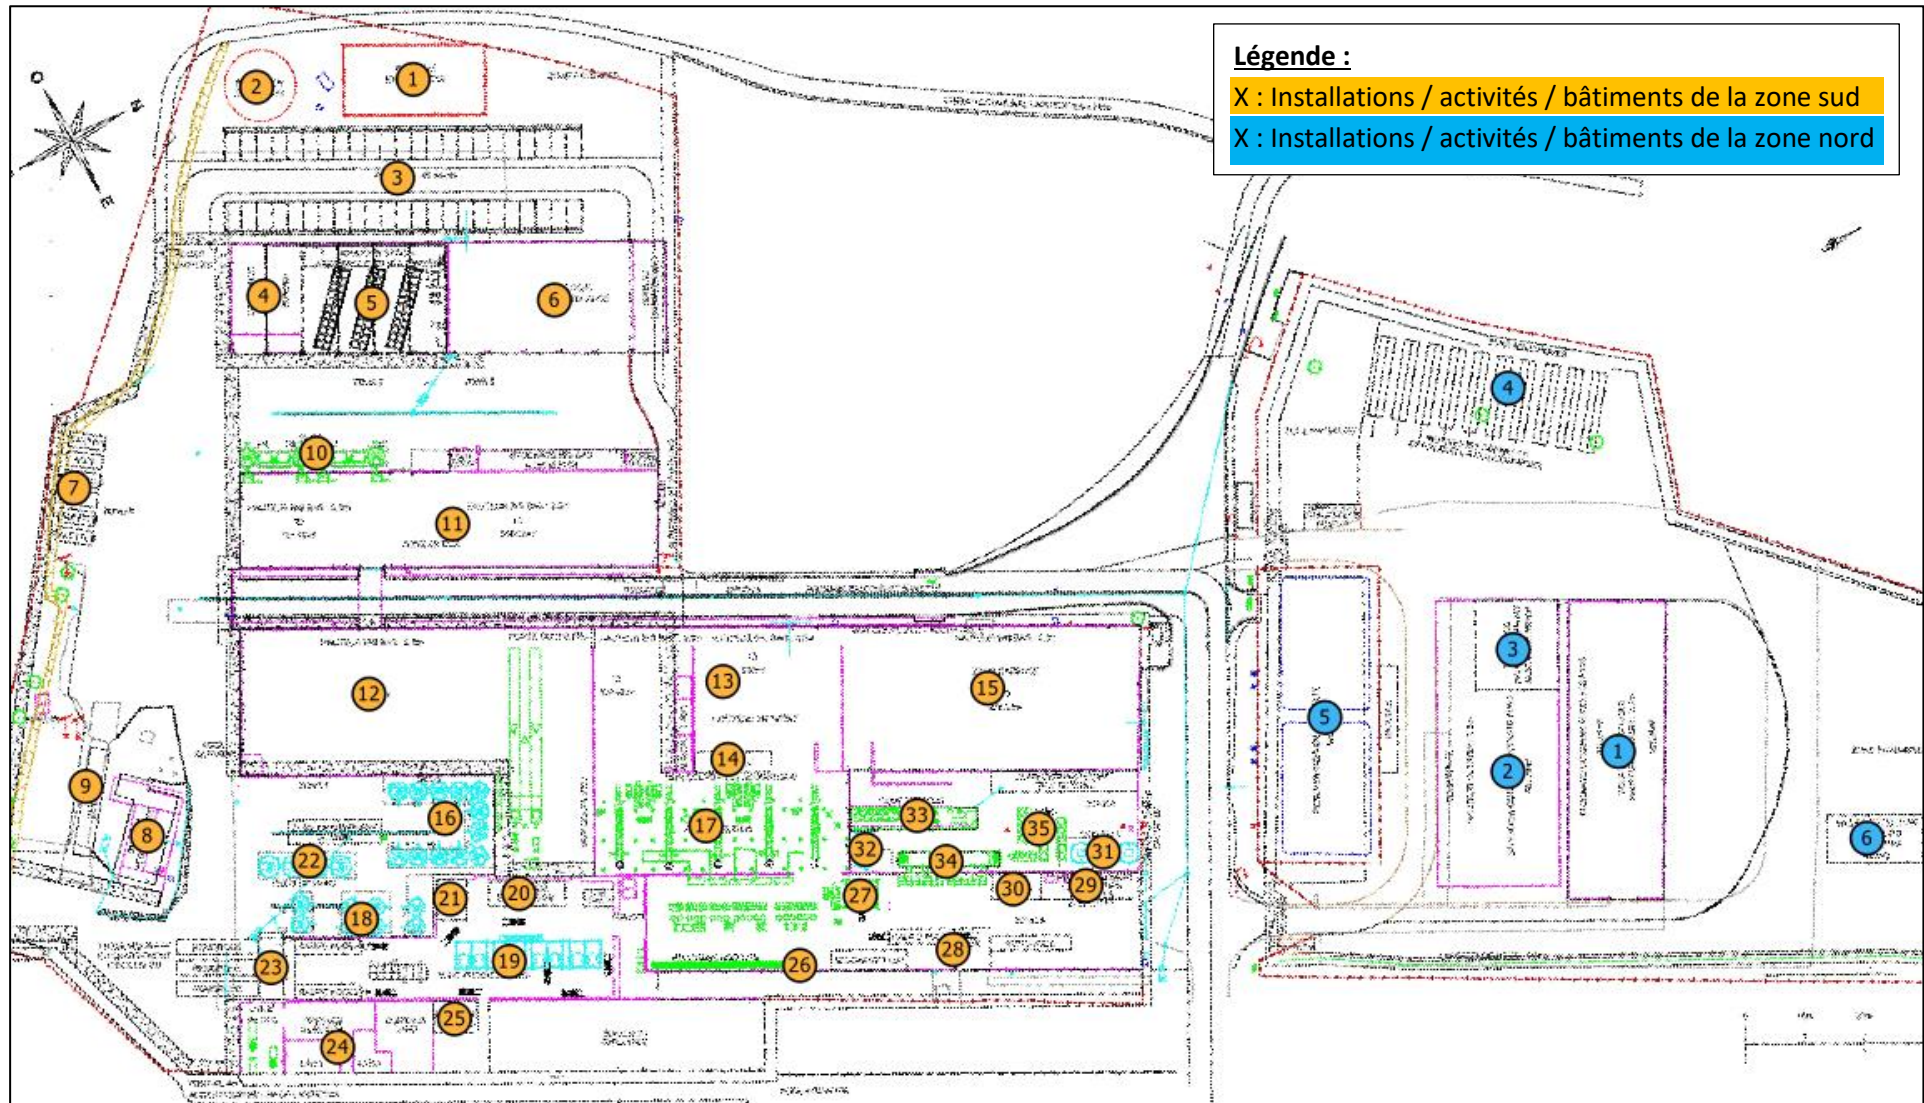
PLAN SCHEMATIQUE DES INSTALLATIONS ET ACTIVITES (SOURCE : SYNOVA)
